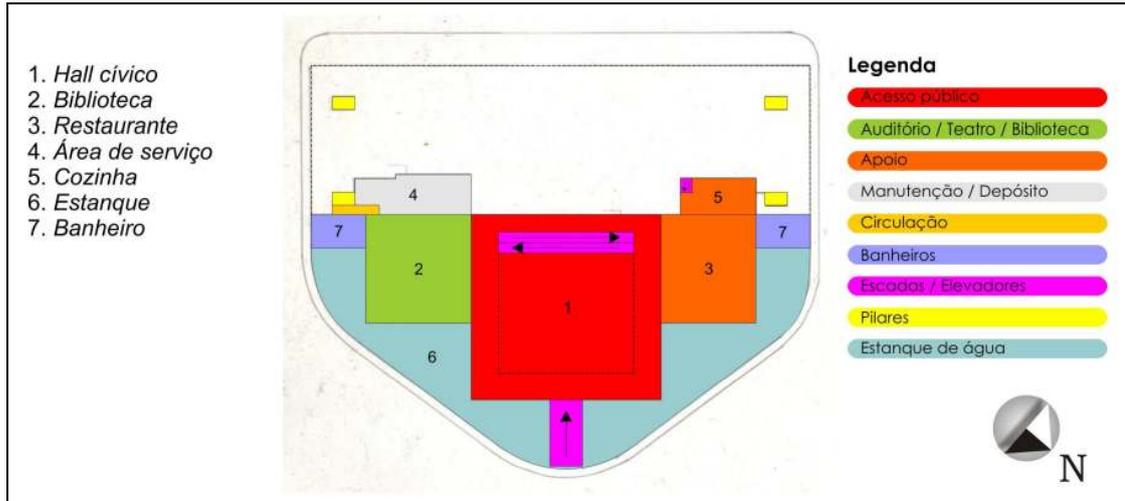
Planta baixa do 2º nível de subsolo (adaptada de BARDI, 1992).
